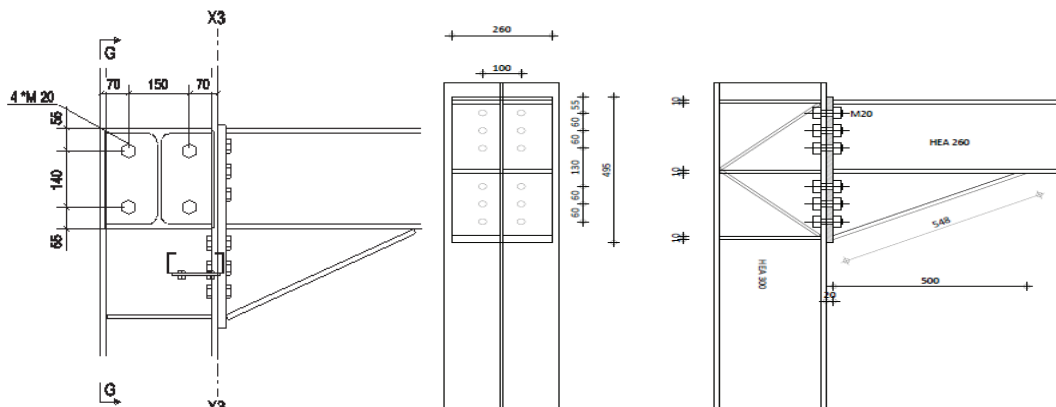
Pormenor de ligação entre as vigas das palas previsto em projeto.
